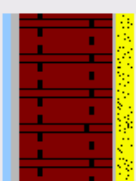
Creación fachada doble con cámara aire ventilada en LIDER
